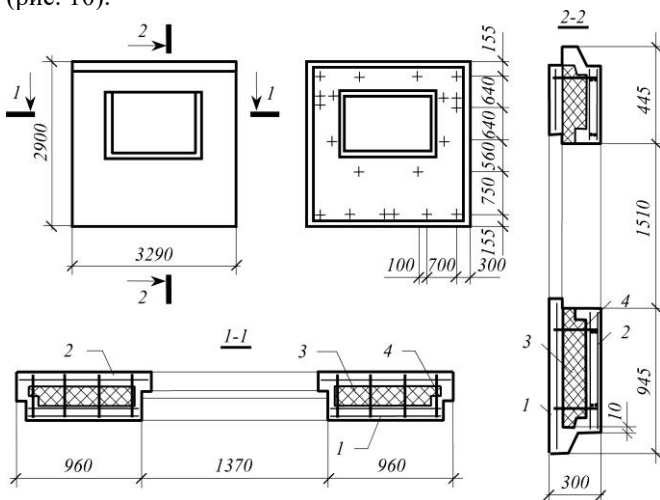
Тришарова залізобетонна стінова панель із гнучкими в'язями для малоповерхових сільських житлових будівель, що формується "лицем донизу": 1 – внутрішній залізобетонний шар товщиною 95 мм; 2 – зовнішній залізобетонний шар товщиною 80 мм; 3 – полістирольний пінопласт товщиною 125 мм; 4 – гнучкі в'язі.
